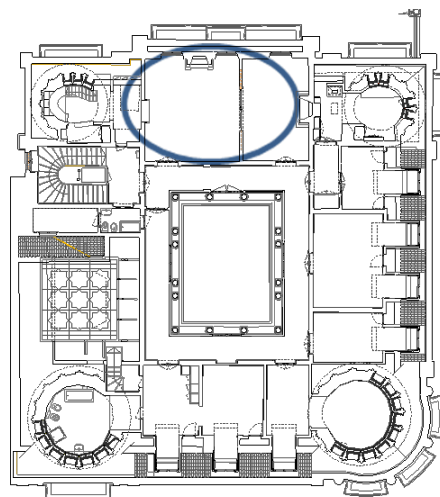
P R C - Planta Piso 1 em 2014.
